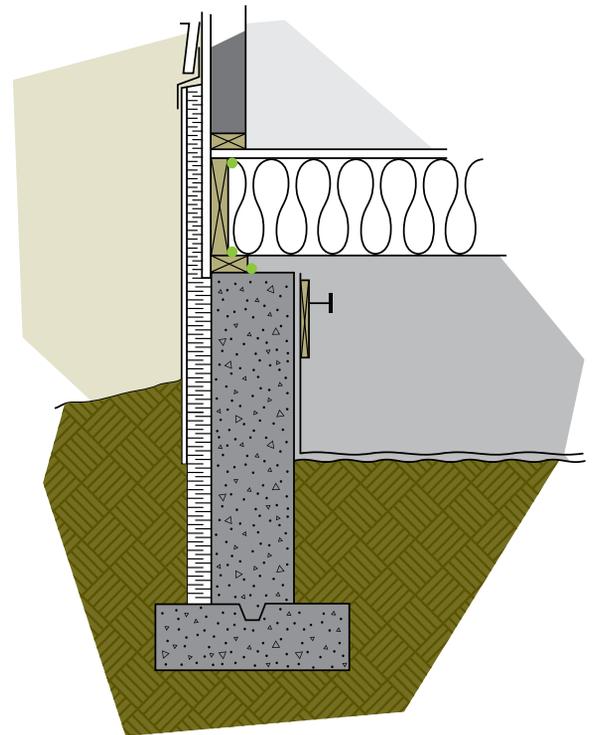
L'isolation d'un vide sanitaire de l'extérieur se fait de la même façon que l'isolation d'un mur de fondation pleine hauteur
